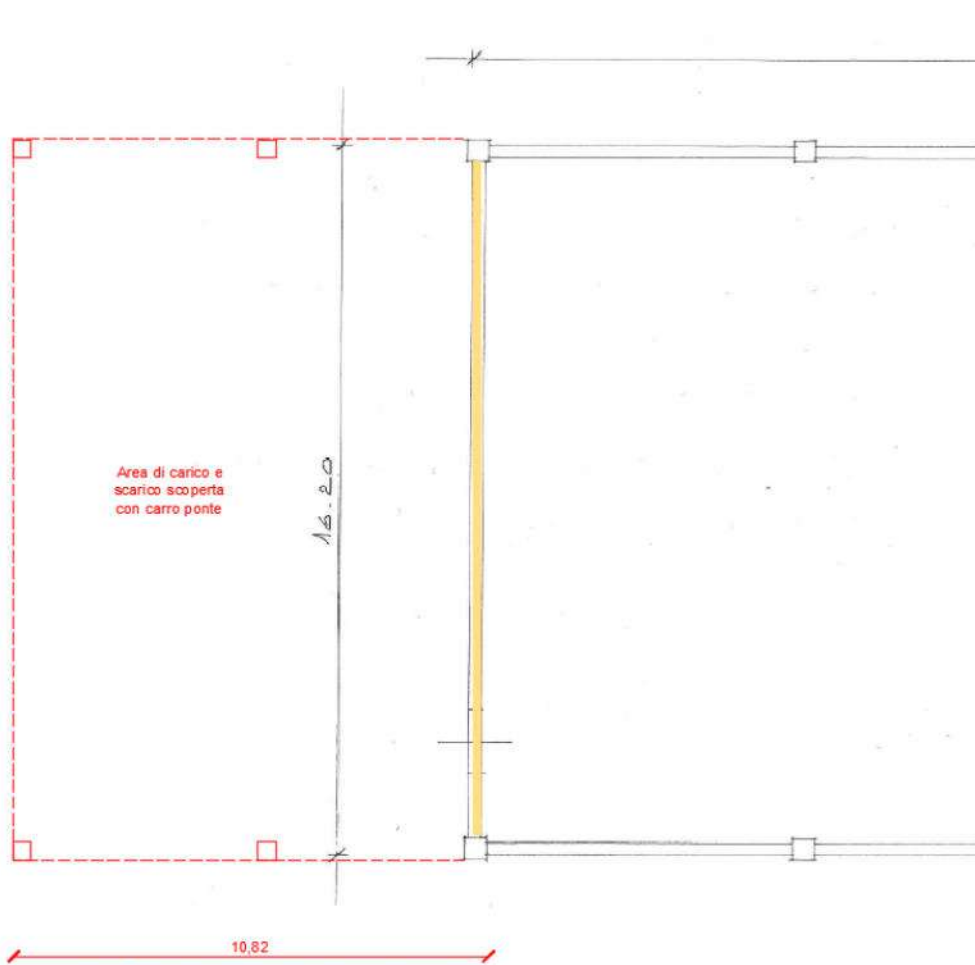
3/3 stralcio Pianta piano terra, è stata realizzata un'area di carico e scarico , con pavimentazione in cemento dotata di pilastri per carro ponte - Fuori Scala
